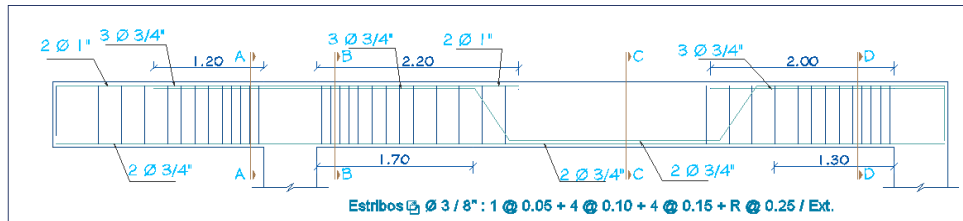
Esquema de la viga principal Pabellón 1A.
